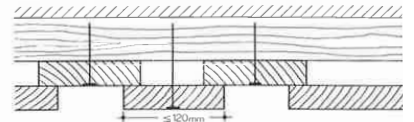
Planches simples: rabotées ou brutes de sciage; la fixation ne doit pas empêcher les planches de travailler.
